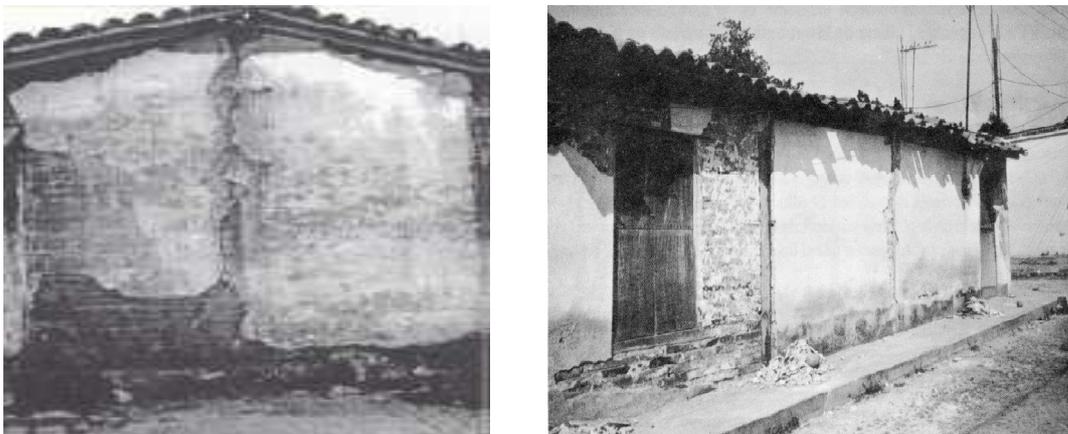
Falla por flexión fuera del plan (Sordo y otros, 1996)
